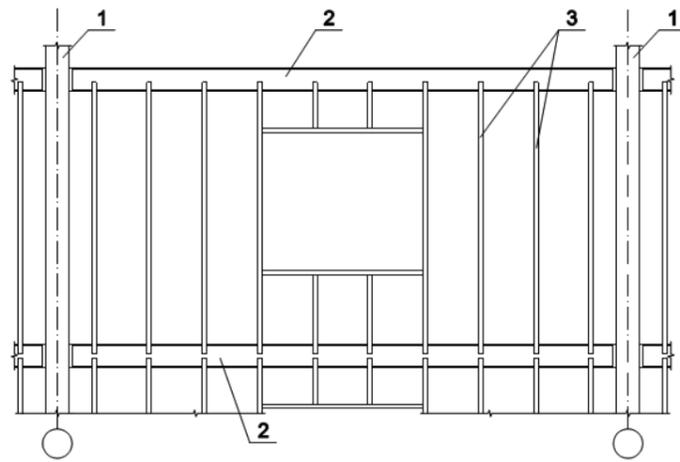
Схема расположения стоек каркаса стены стоечно-ригельной конструкции. 1-колонна, 2-ригель, 3- стойки каркаса стены
